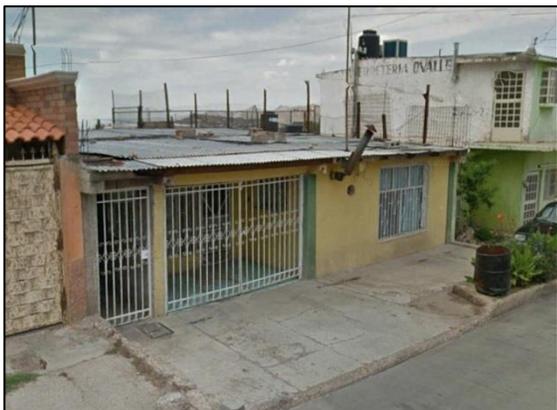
Tipología de vivienda en la zona objeto del presente estudio.
